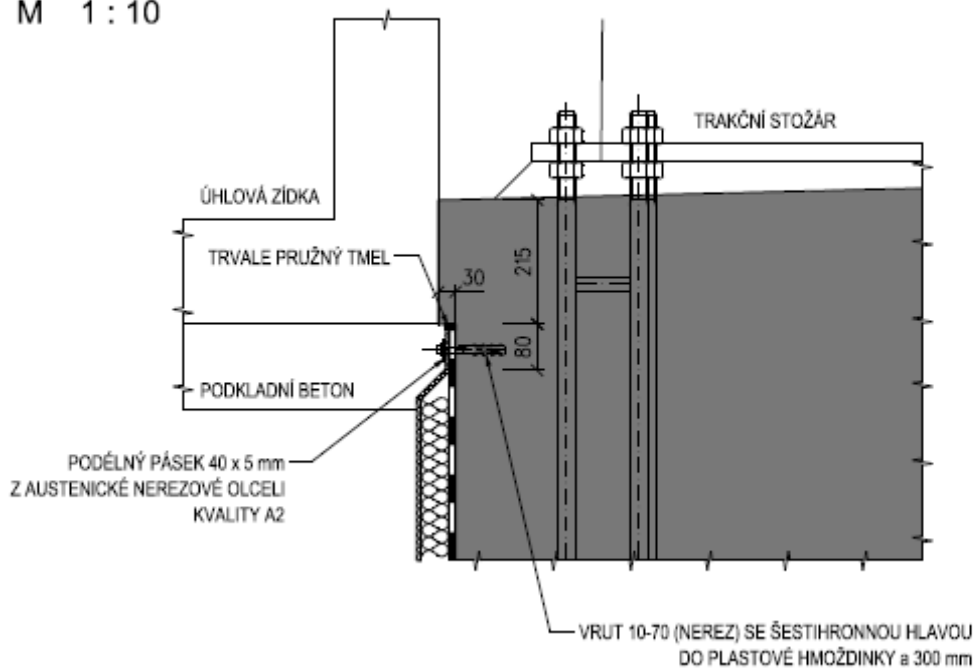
ODVODNĚNÍ ZA RUBEM, 1. ČÁST M 1 : 10
